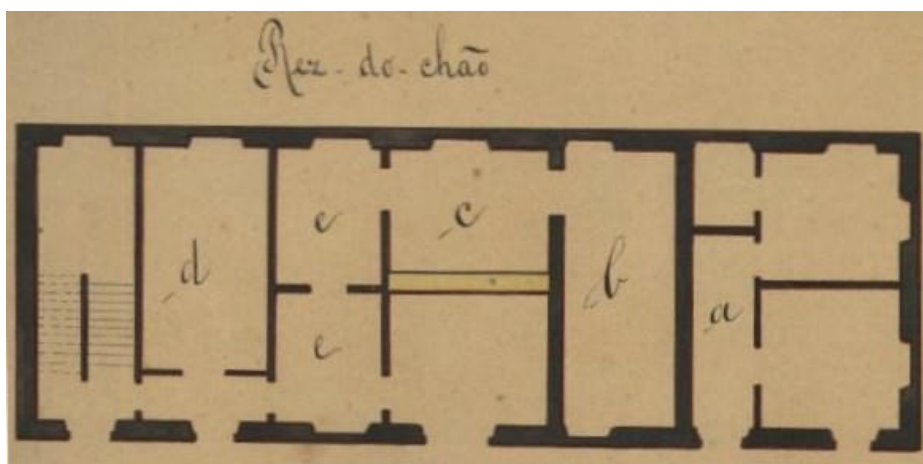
Detalhe da Planta do Edifício do Cofre Central, Álbum do Mendo Bem (Anexo 9)
